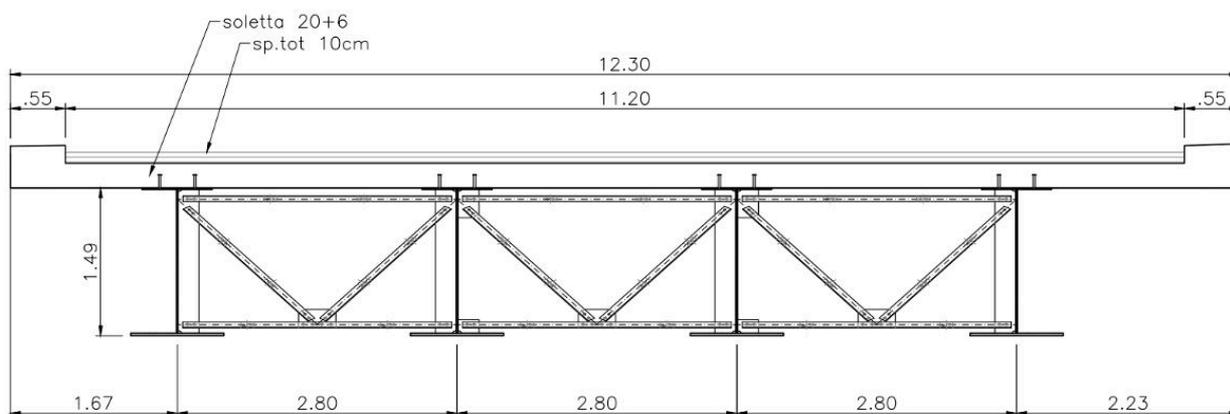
Sezione trasversale tipo – impalcato in progetto (singola carreggiata) (Fonte: lista di controllo)
